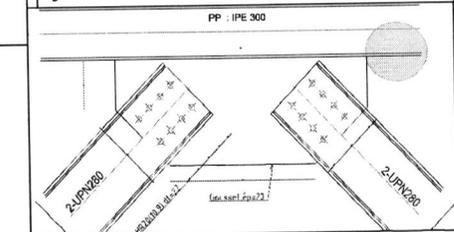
D.A : contreventement V renversé + poutre. ECH 1/20
